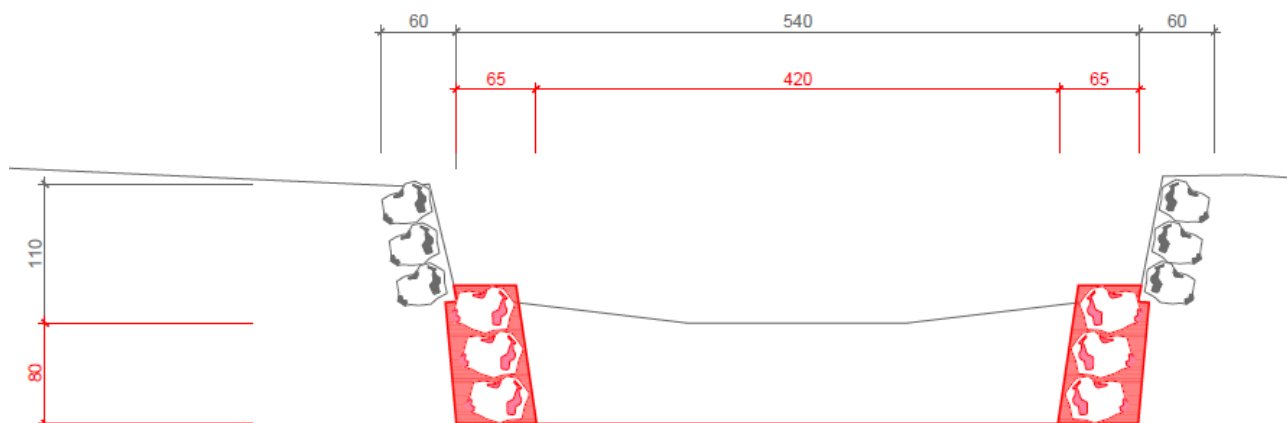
Principe d'approfondissement du lit de 80 cm pour un profil avec murs – coupe-type PK 1.850
